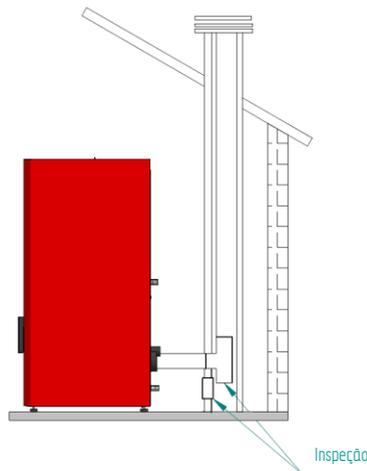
Vista lateral da instalação com chaminé, com exemplo do ponto de inspeção
